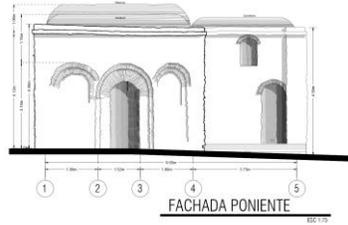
Fachada principal (poniente) del estado actual de la Casa de Éfeso. (Elaboración propia, 2021)
